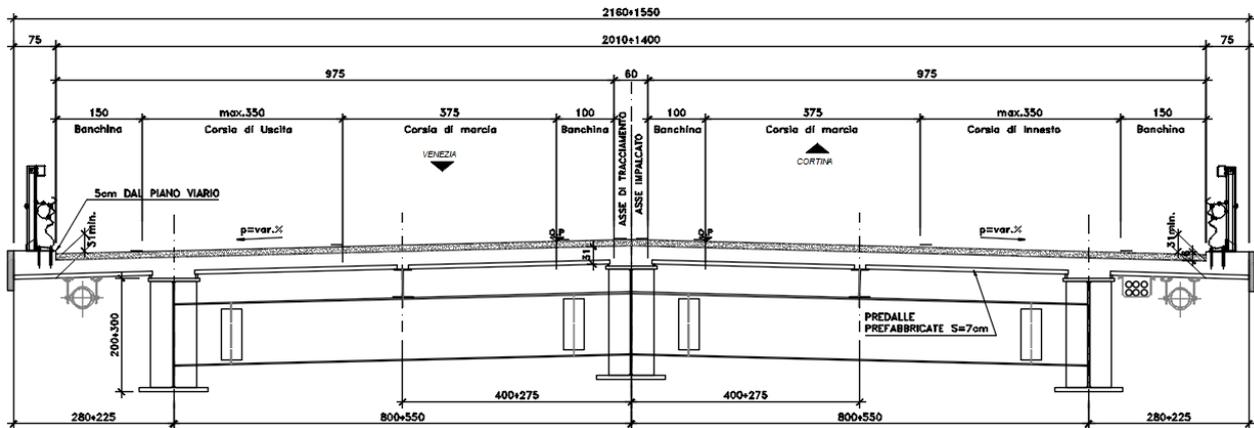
Sezione trasversale impalcato tra pila SPA e pila P2.
